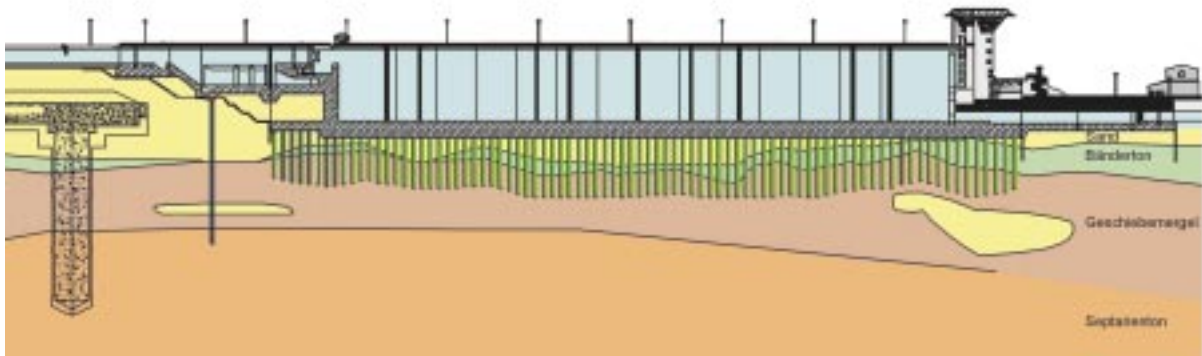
Längsschnitt Schleuse Hohenwarthe mit Pfahlgründung und Baugrunderdarstellung
